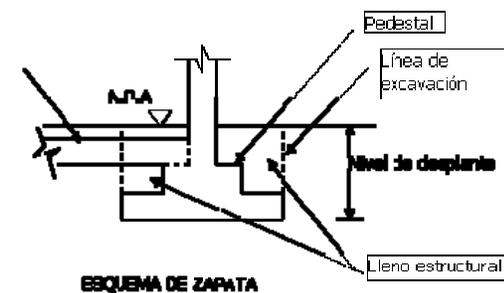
DETALLE DE ZAPATA AISLADA.
